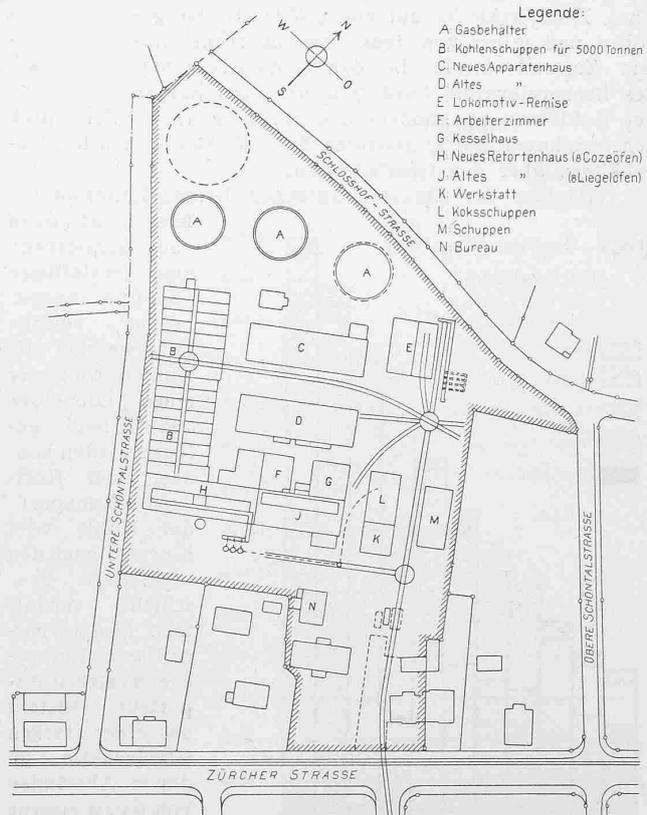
Lageplan der Gasfabrik. — Masstab 1 : 2500.
